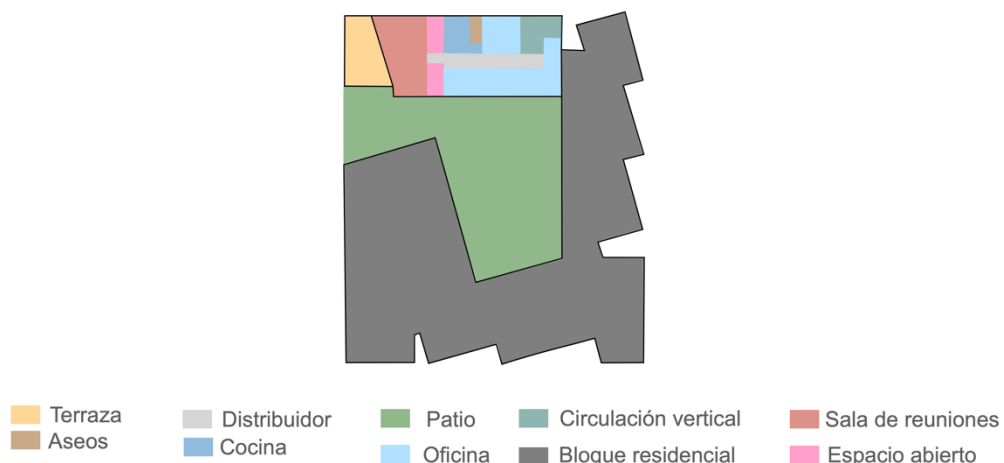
Distribución de espacio de la planta alta. Fuente: Autoría propia.
